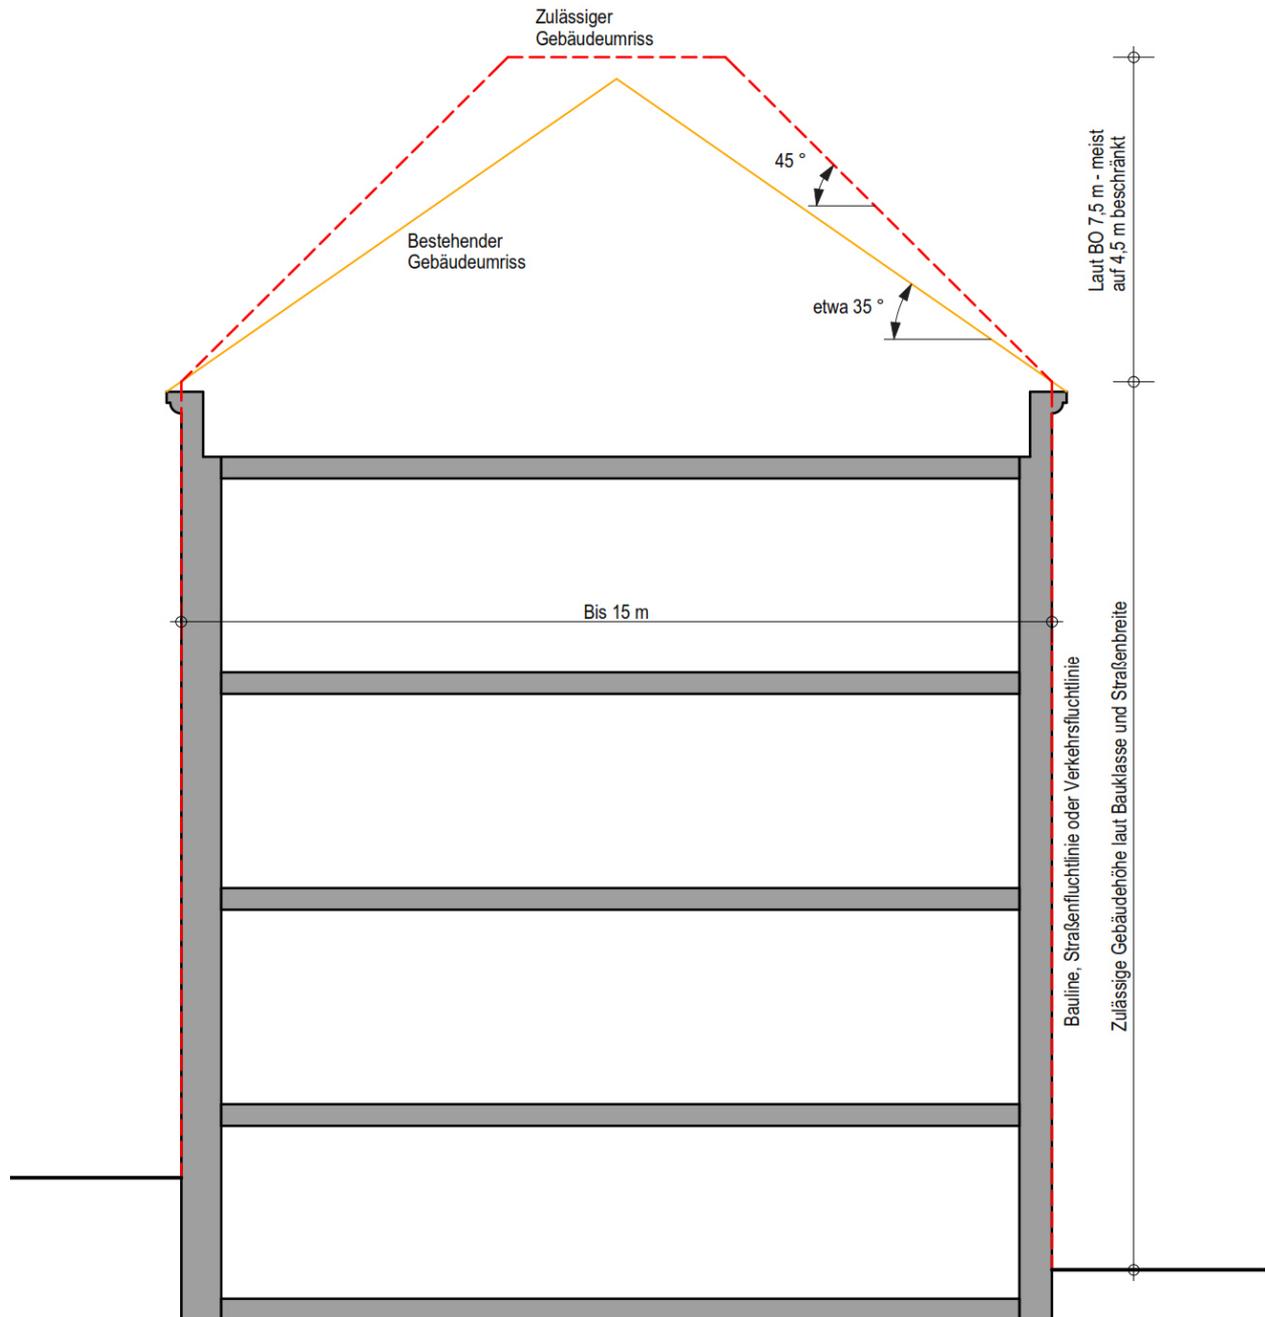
Darstellung einer Aufklappung aus baurechtlicher Sicht. Die gelbe Linie stellt den Dachstuhl vor dem Dachbodenausbau dar, die rot-gestrichelte Linie stellt die mögliche Erweiterung des Umrisses im Zuge eines Dachbodenausbaus dar.
